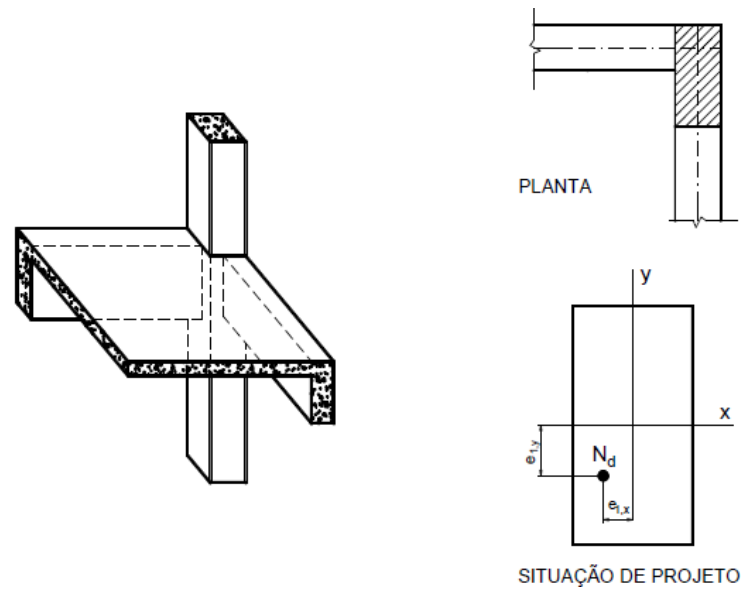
Arranjo estrutural e situação de projeto dos pilares de extremidade
